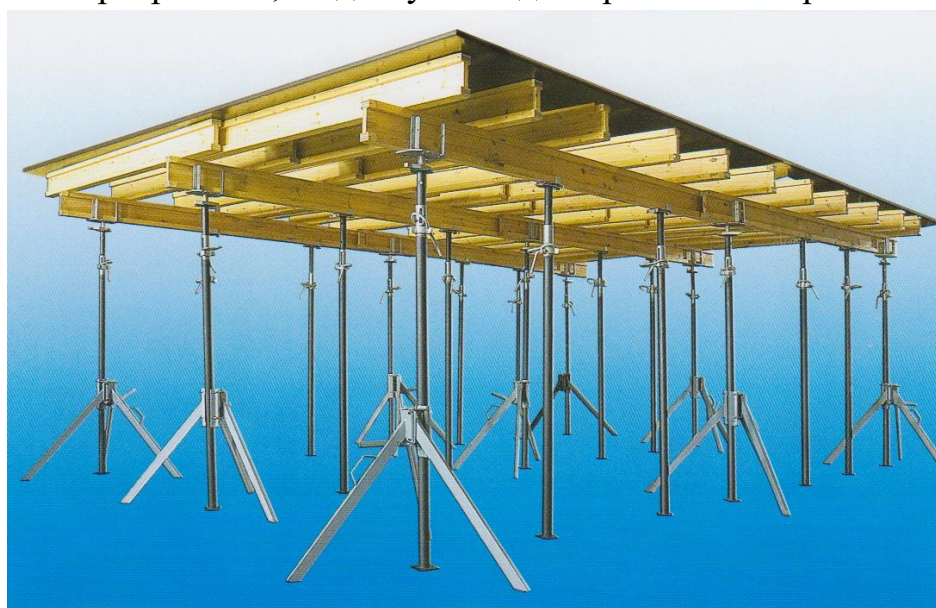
Опалубка горизонтальных монолитных конструкций
